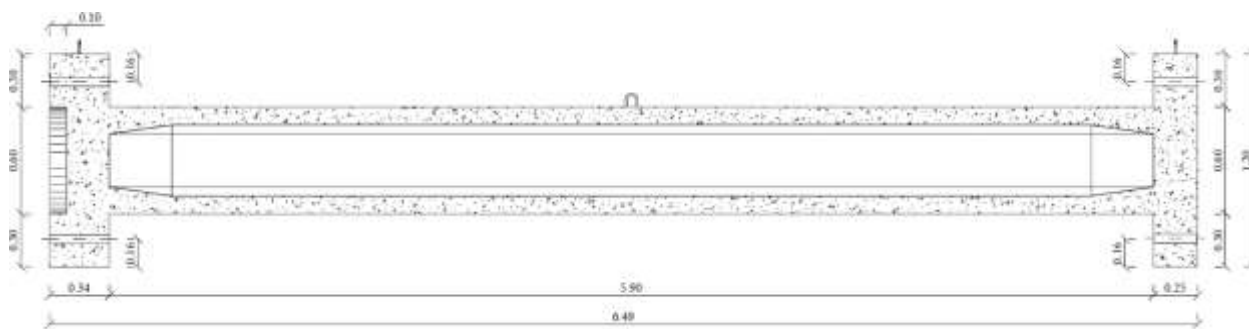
Corte longitudinal da viga de referência A2 [17]
